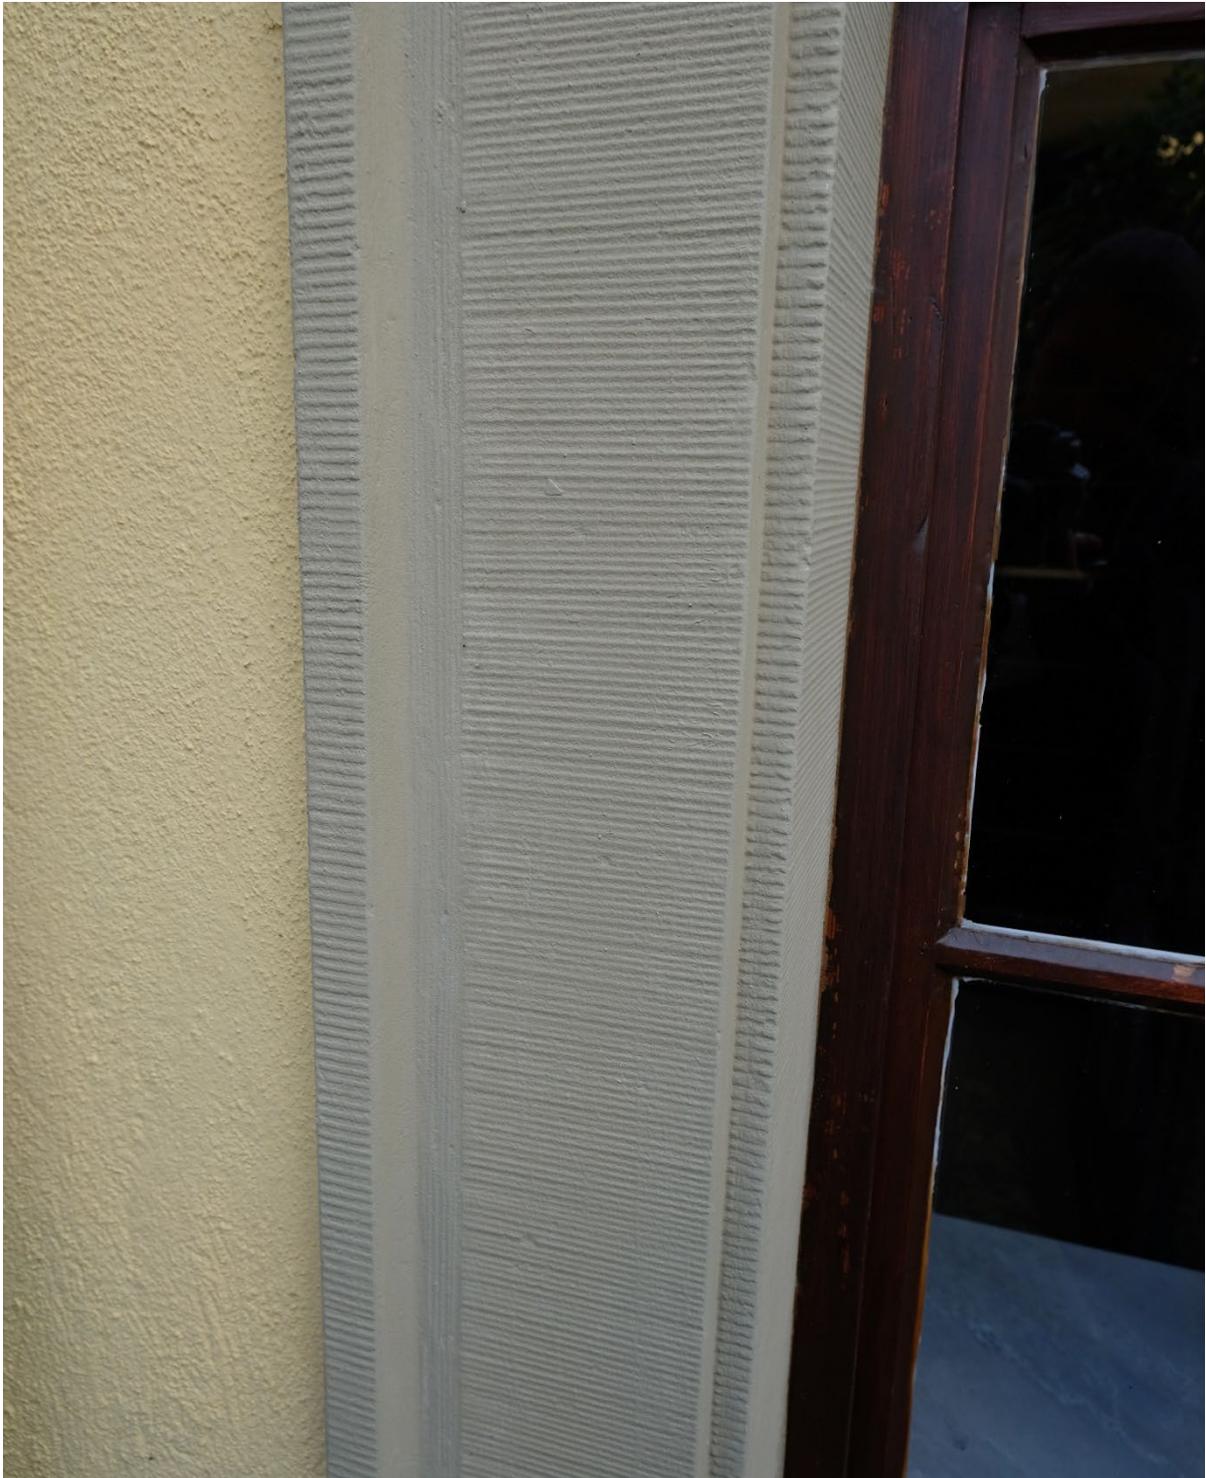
Ostseite, Detail Fenster (Datierung nach 1945)
